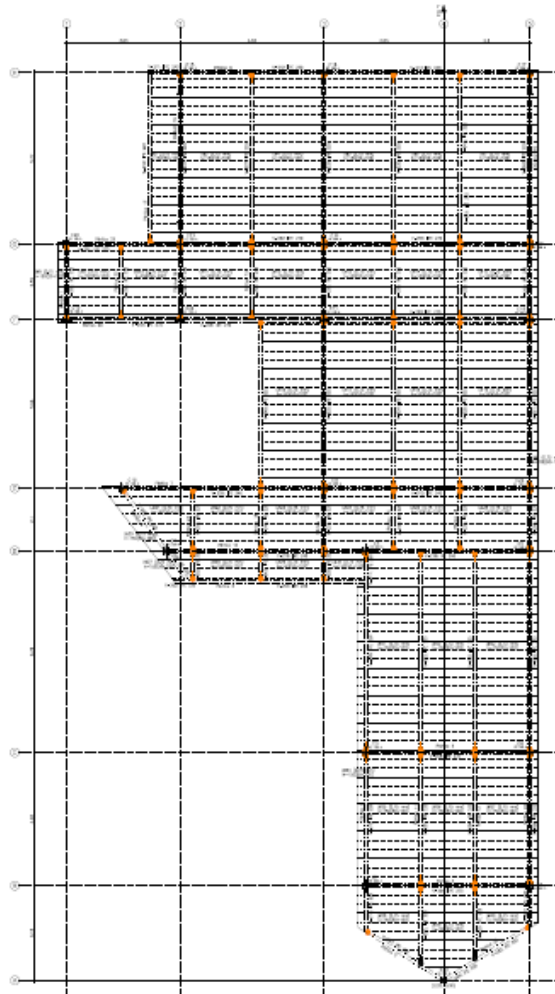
Replanteo Entrepiso. Colegio. CAJAMAG.
